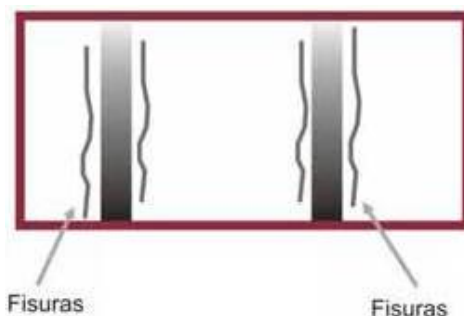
Fissuras regulares falhas na execução do revestimento
